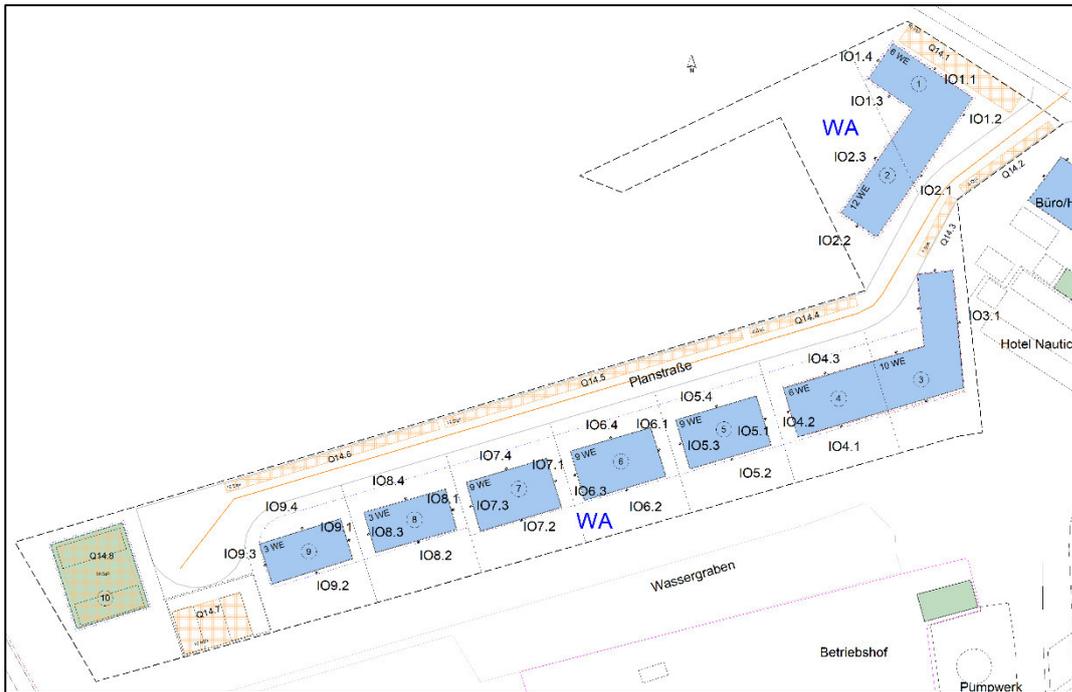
Lage der nichtöffentlichen Stellplätze und der Planstr. des Bauvorhabens
